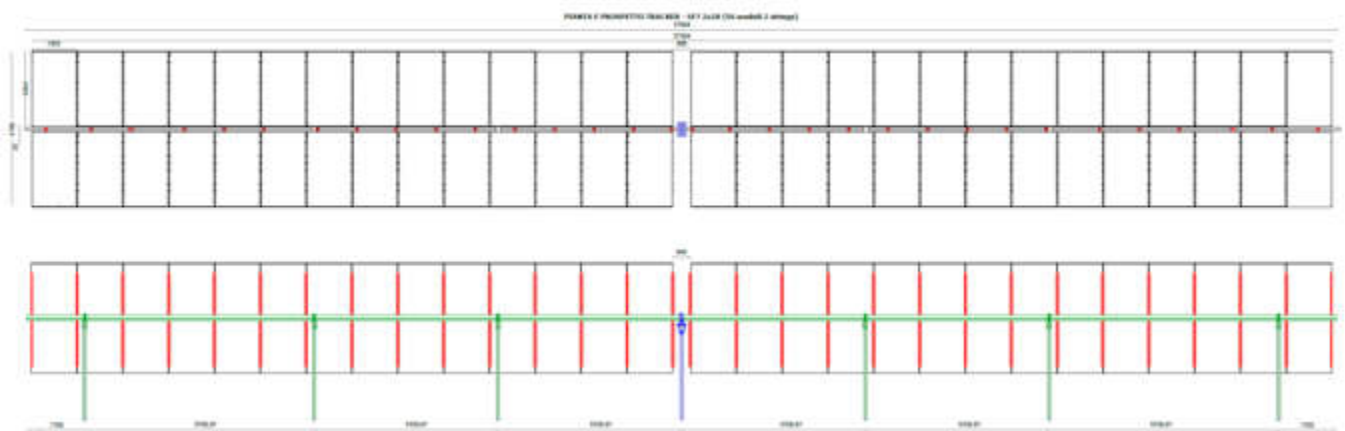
Pianta e prospetto tracker - SF7 2x28 (56 moduli 2 strings)
